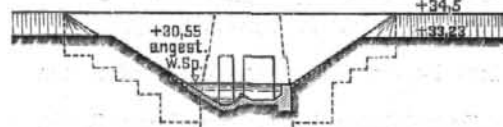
Mittelwässerdücker. Einlauf. Schnitt a a.
